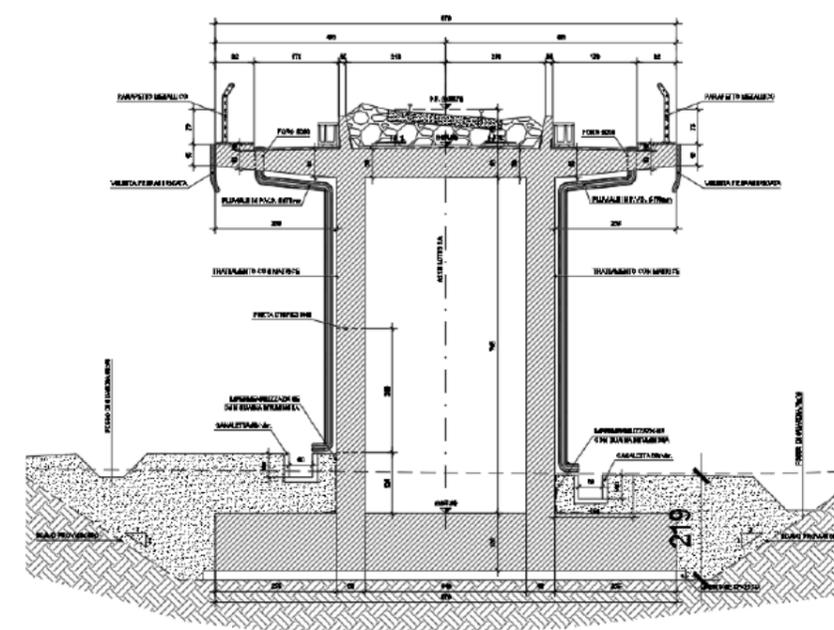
Sezione trasversale Manufatto scatolare di approccio ai viadotti
